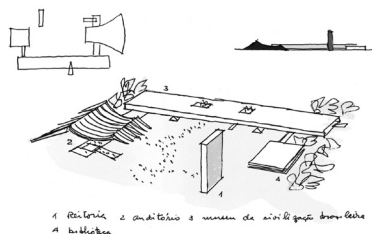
Plano Piloto da UnB – Lucio Costa.
